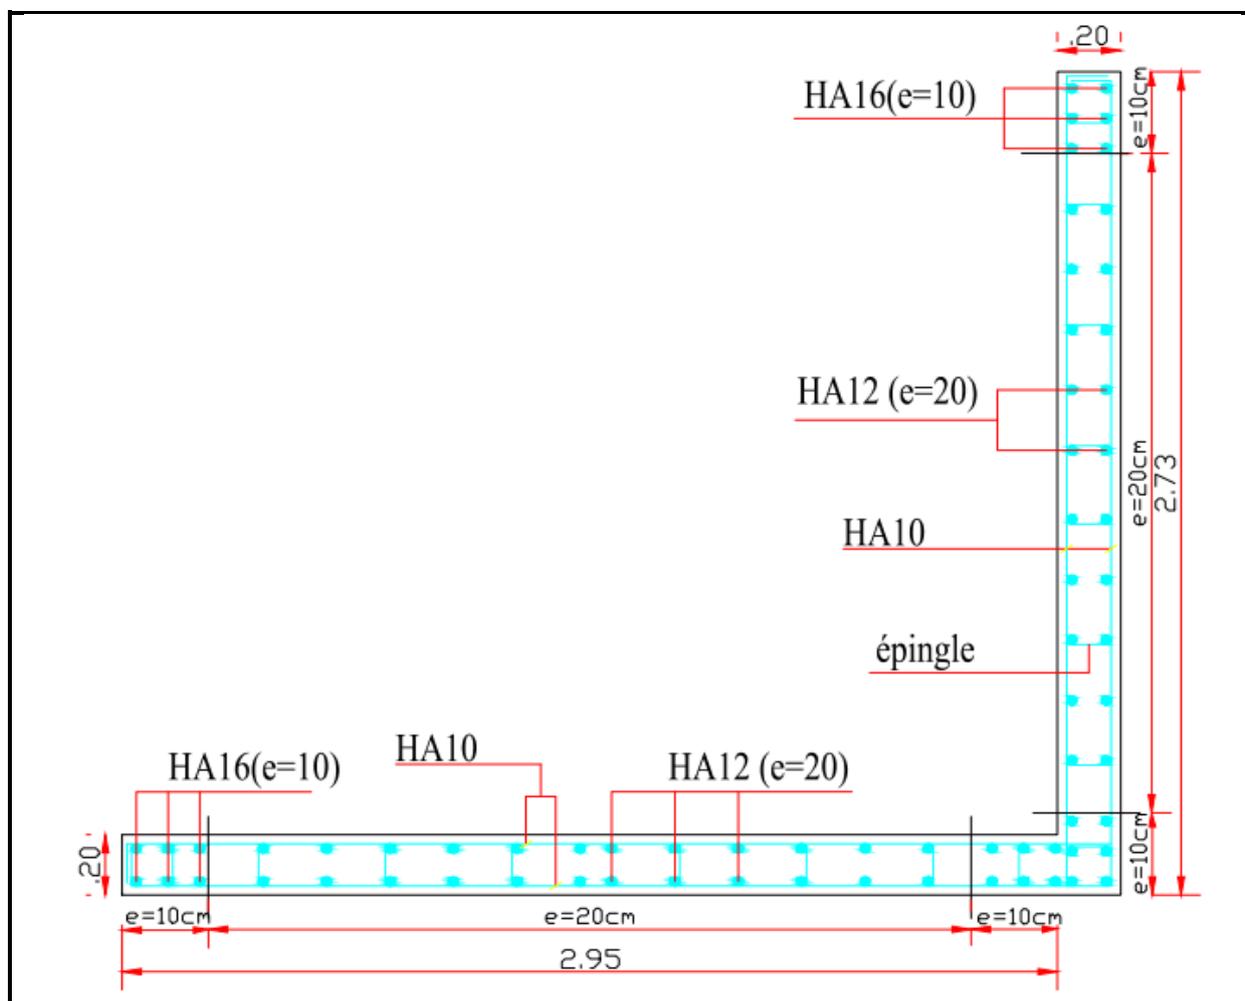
ferraillage coupe des voiles 02 (RDC, 1^{er} et 2^{ème} étages).
